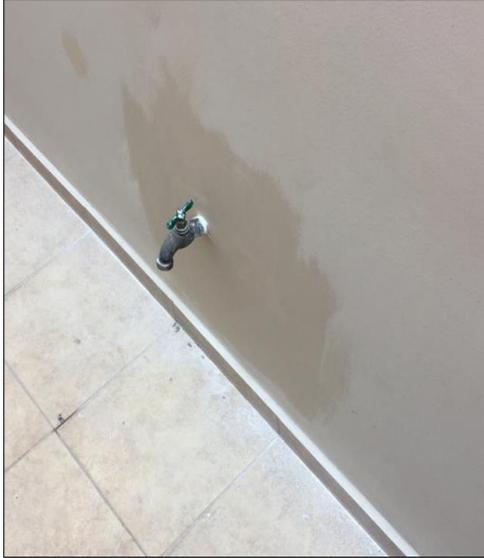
Grifo instalado en su nueva ubicación, a 0.40 m del nivel de piso
